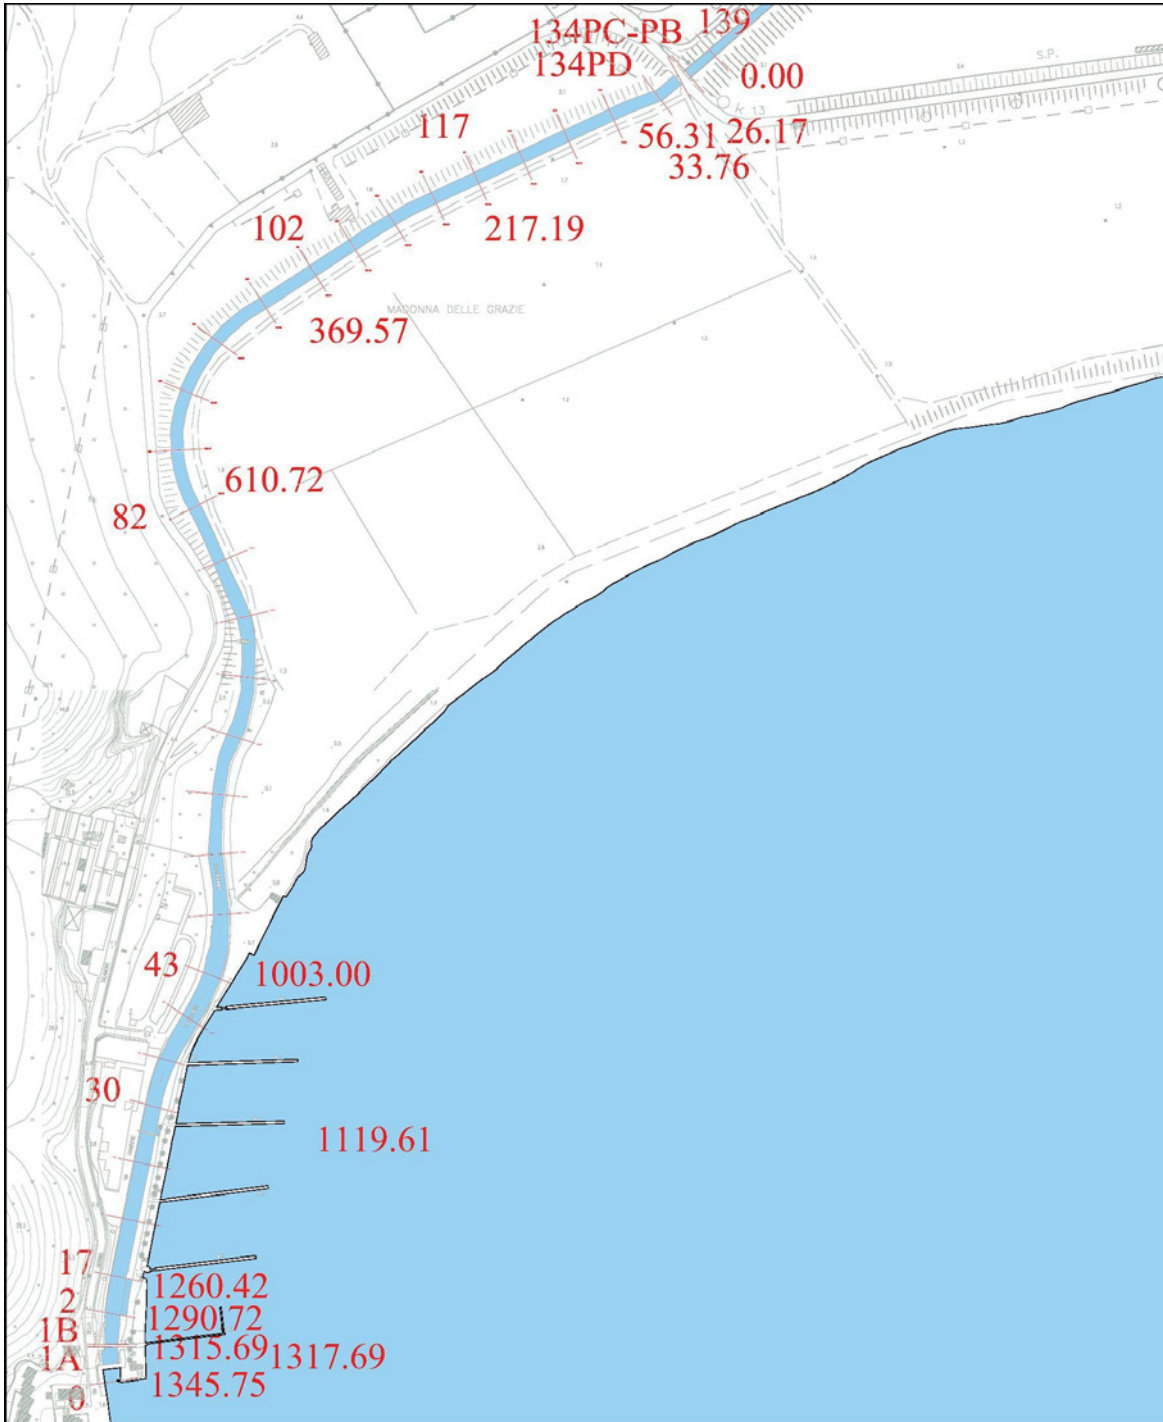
Soluzione progettuale originaria - Planimetria e sezioni di calcolo del tratto di valle del Collettore Occidentale tra il ponte sulla strada provinciale n.1 e la foce attuale
